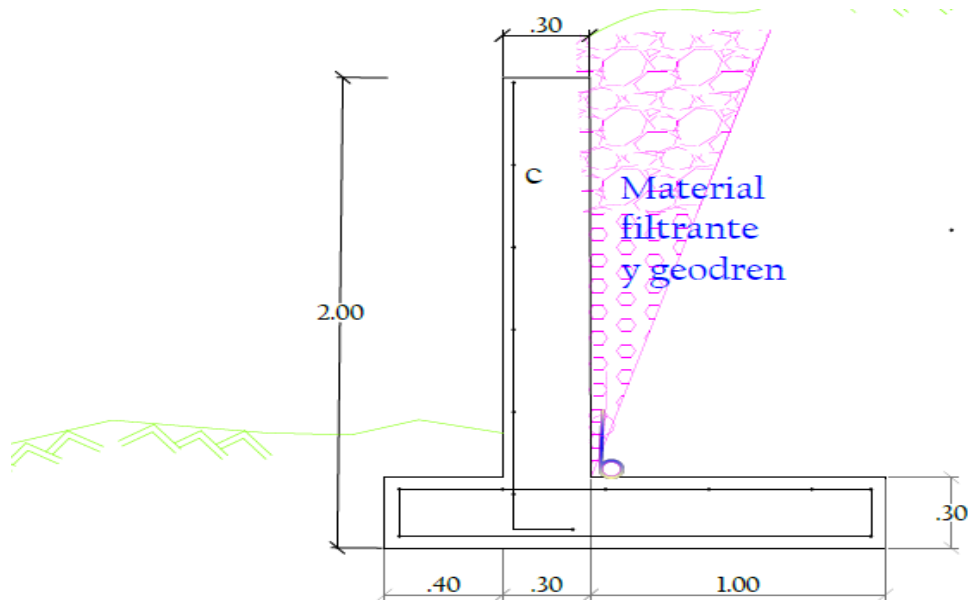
Corte sección transversal de estribos del muro el trebol
